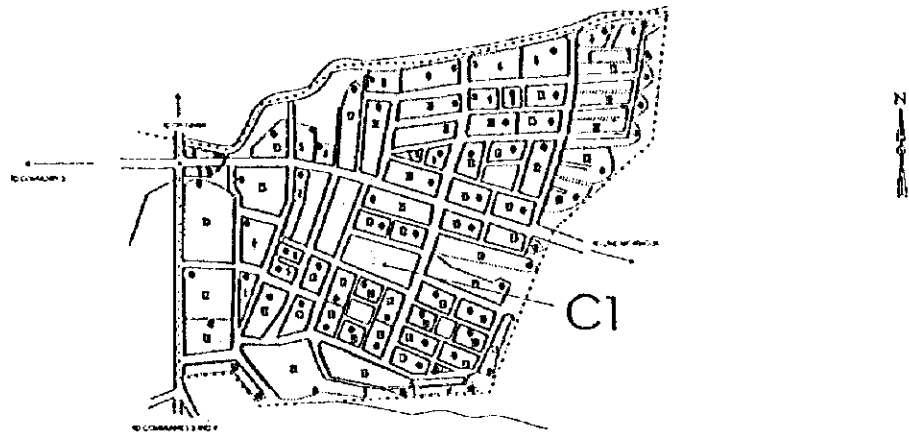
Plan de Distribución de los Sistemas *In-Situ* (Zona "C1")
